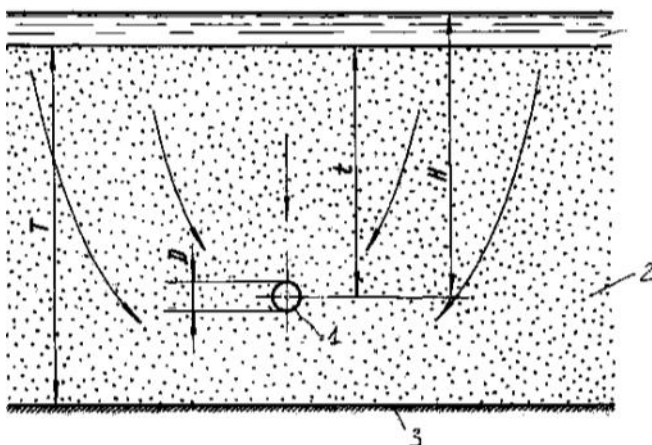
Схема грунтового лотка для испытаний дренажных конструкций по принципу подрусловой дрены
